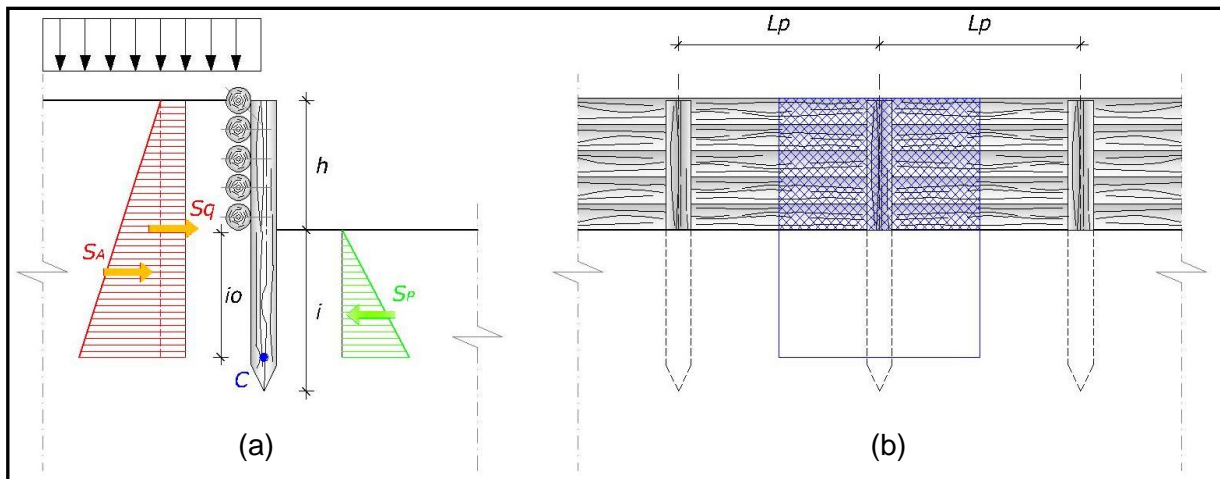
Schema statico della palizzata (a) ed area di influenza del singolo palo verticale (b).
